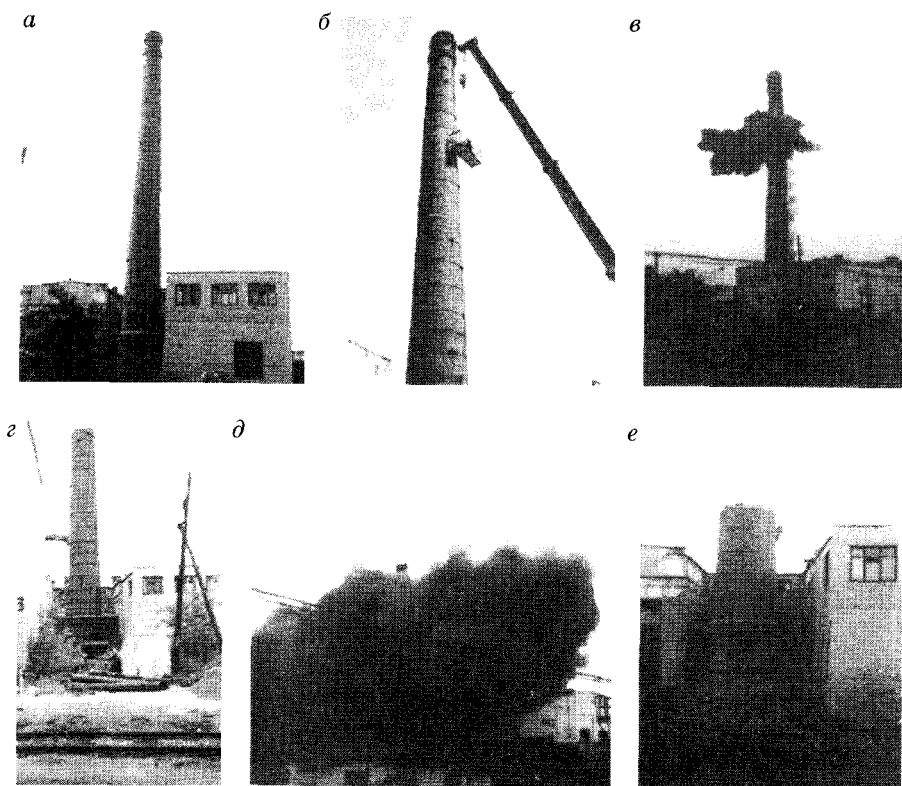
Демонтаж дымовой трубы последовательной срезкой на разных отметках:
